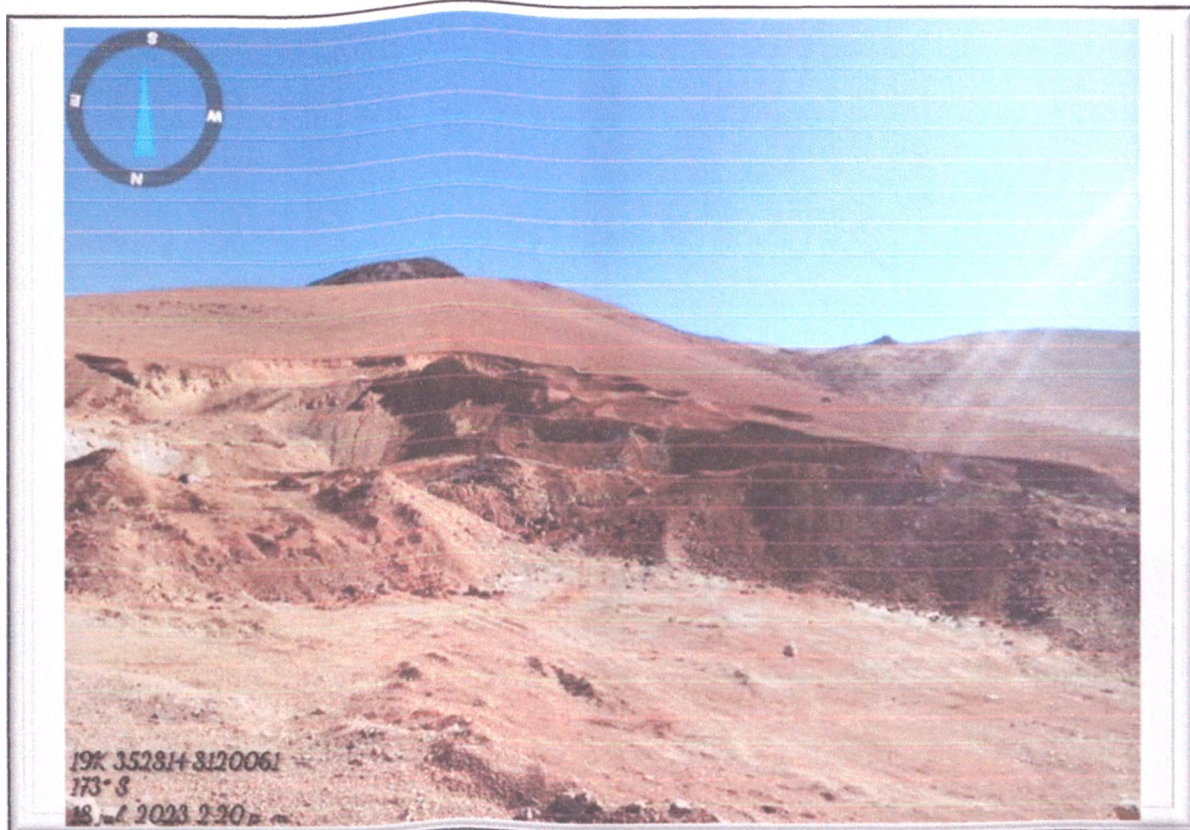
Vista de Cantera 02 (Afirmado) M.D.
